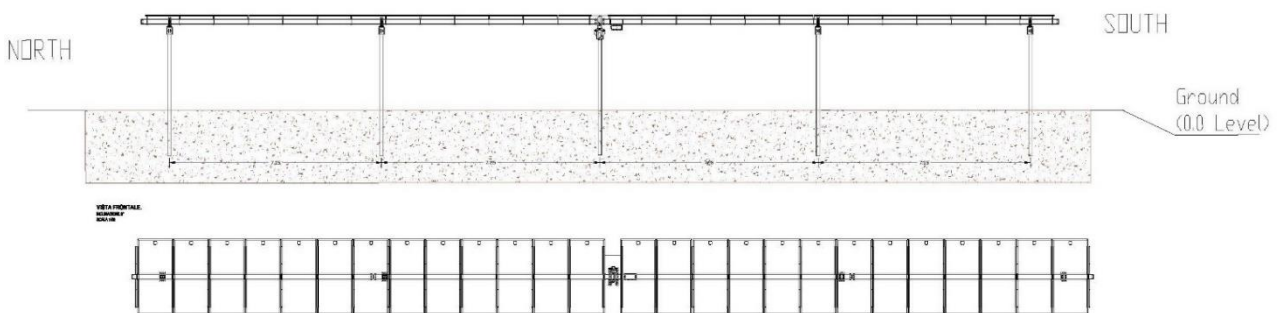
Vista laterale e vista dall'alto della singola stringa da 26 moduli
